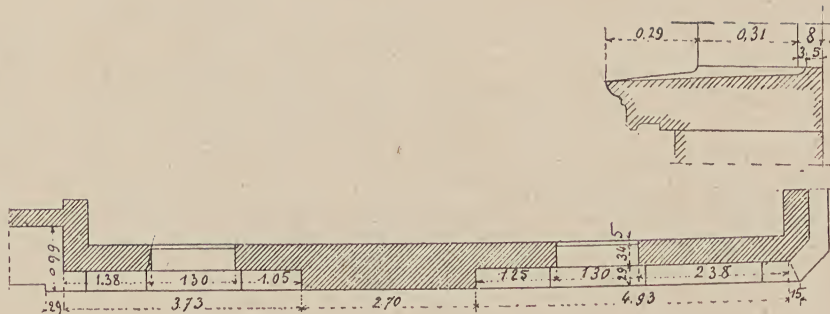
Coupe et plan du balcon en pierre n° 4.
